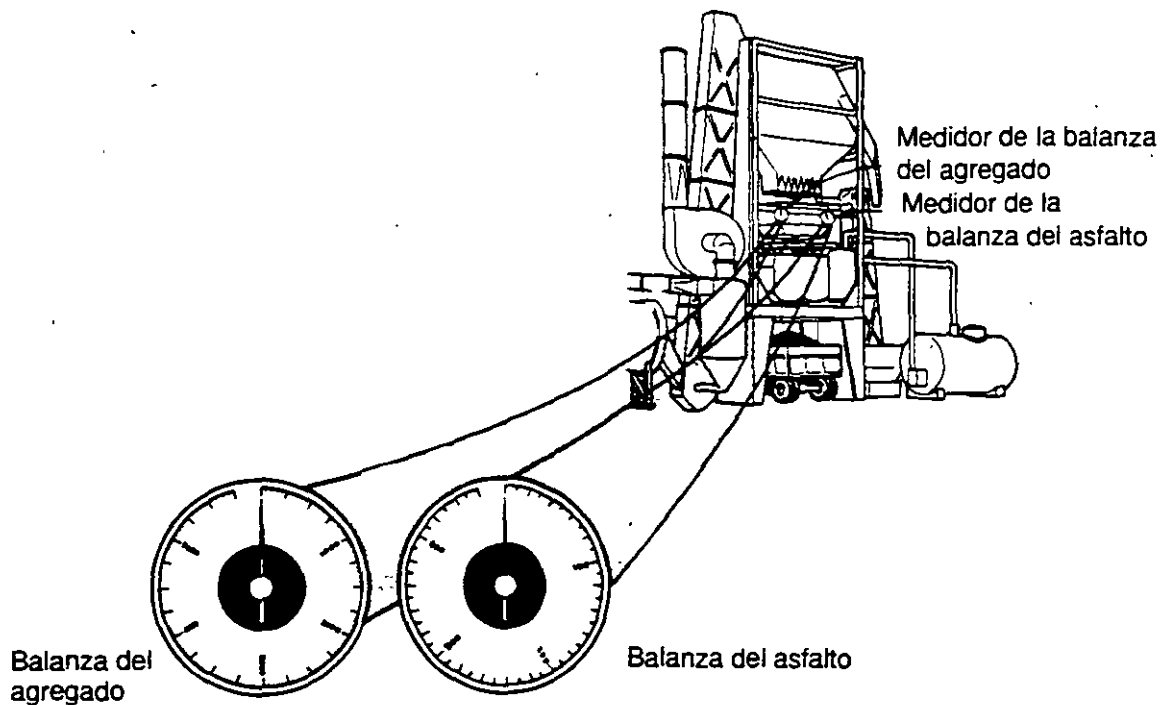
Disposición Típica de las Básculas de la Planta.
